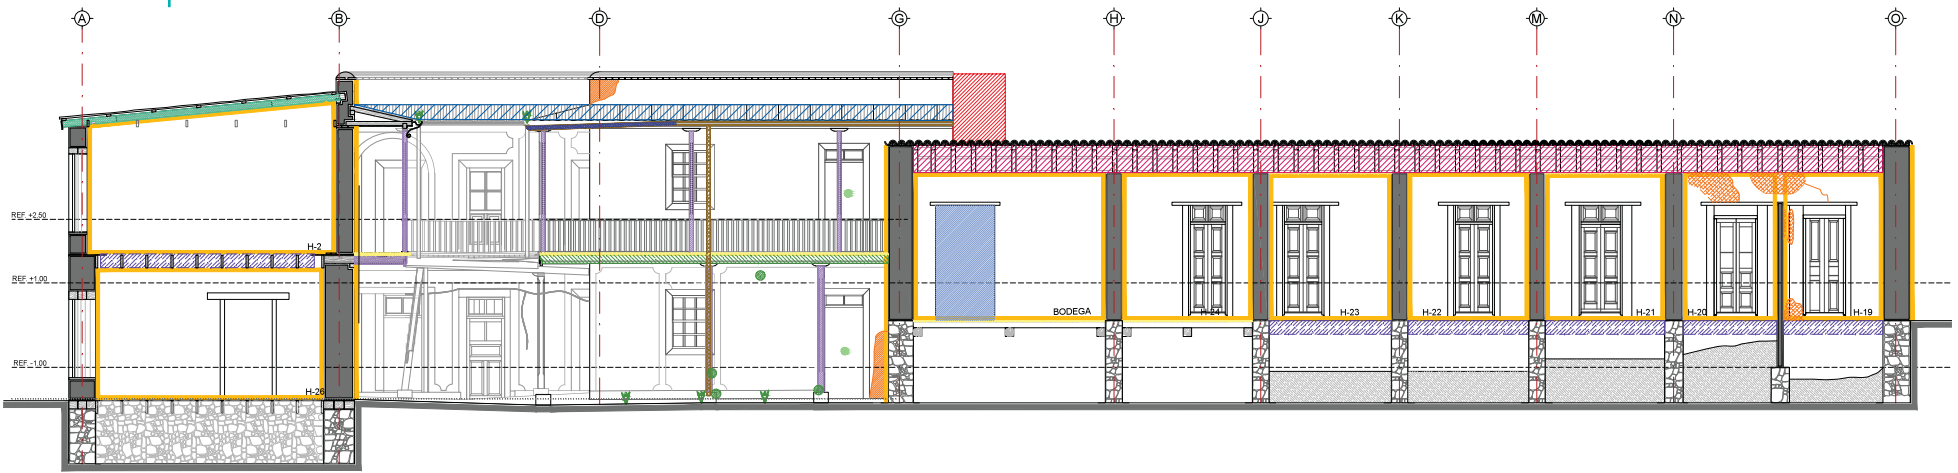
Plano de deterioros. Corte transversal del Hotel del Jardín
